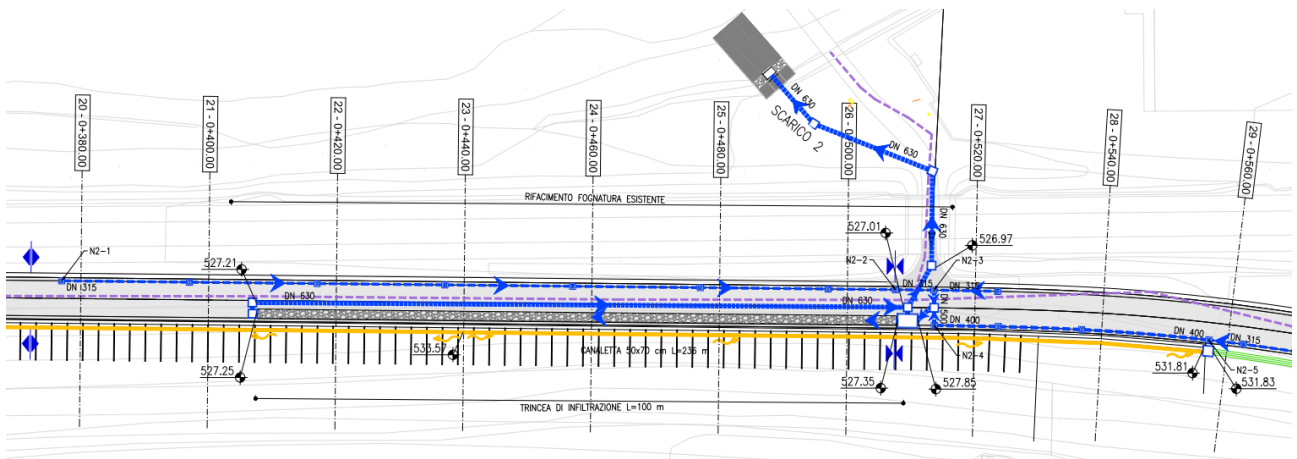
Estratto dalla "Planimetria idraulica" di progetto esecutivo (codifica: IB0U1BEZZP8NV0420001)
